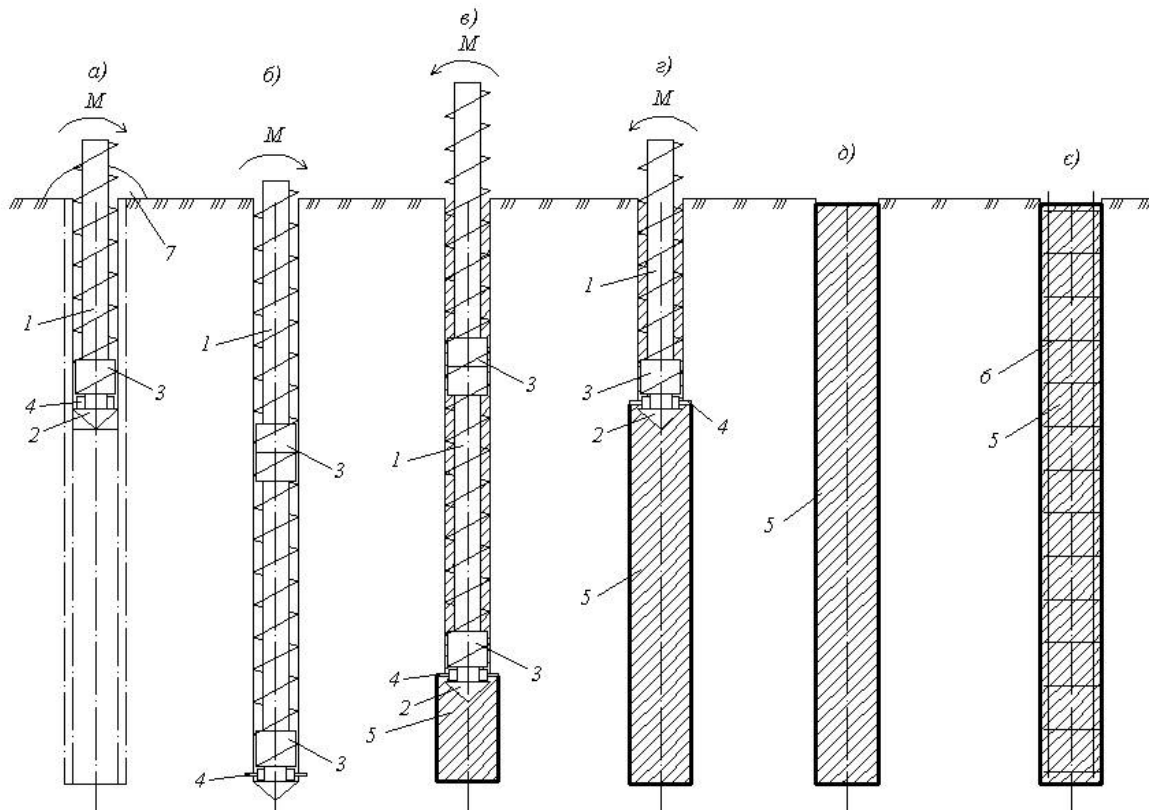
Технологічна схема влаштування ґрунтоцементних паль з частковим вийманням ґрунту: а) буріння свердловини першим шнеком; б) буріння з нарощуванням шнеків; в) перший прохід шнека з розчином; г) перемішування ґрунтоцементу на ділянці; д) палі з перемішаним ґрунтобетоном; є) занурення арматурного каркаса у ґрунтобетон: 1 – шнеки; 2 – наконечник; 3 – муфта з’єднання; 4 – розкладні ножі; 5 – ґрунтобетон; 6 – арматурний каркас; 7 – ґрунт.
